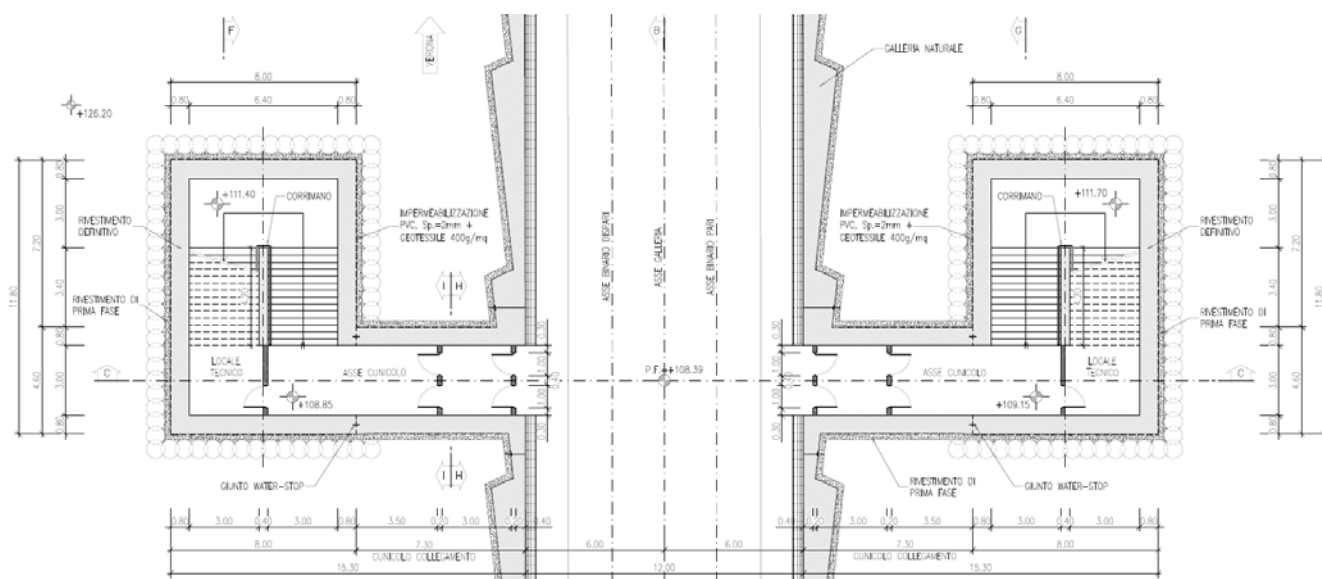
Vista in pianta dell'uscita di sicurezza.
